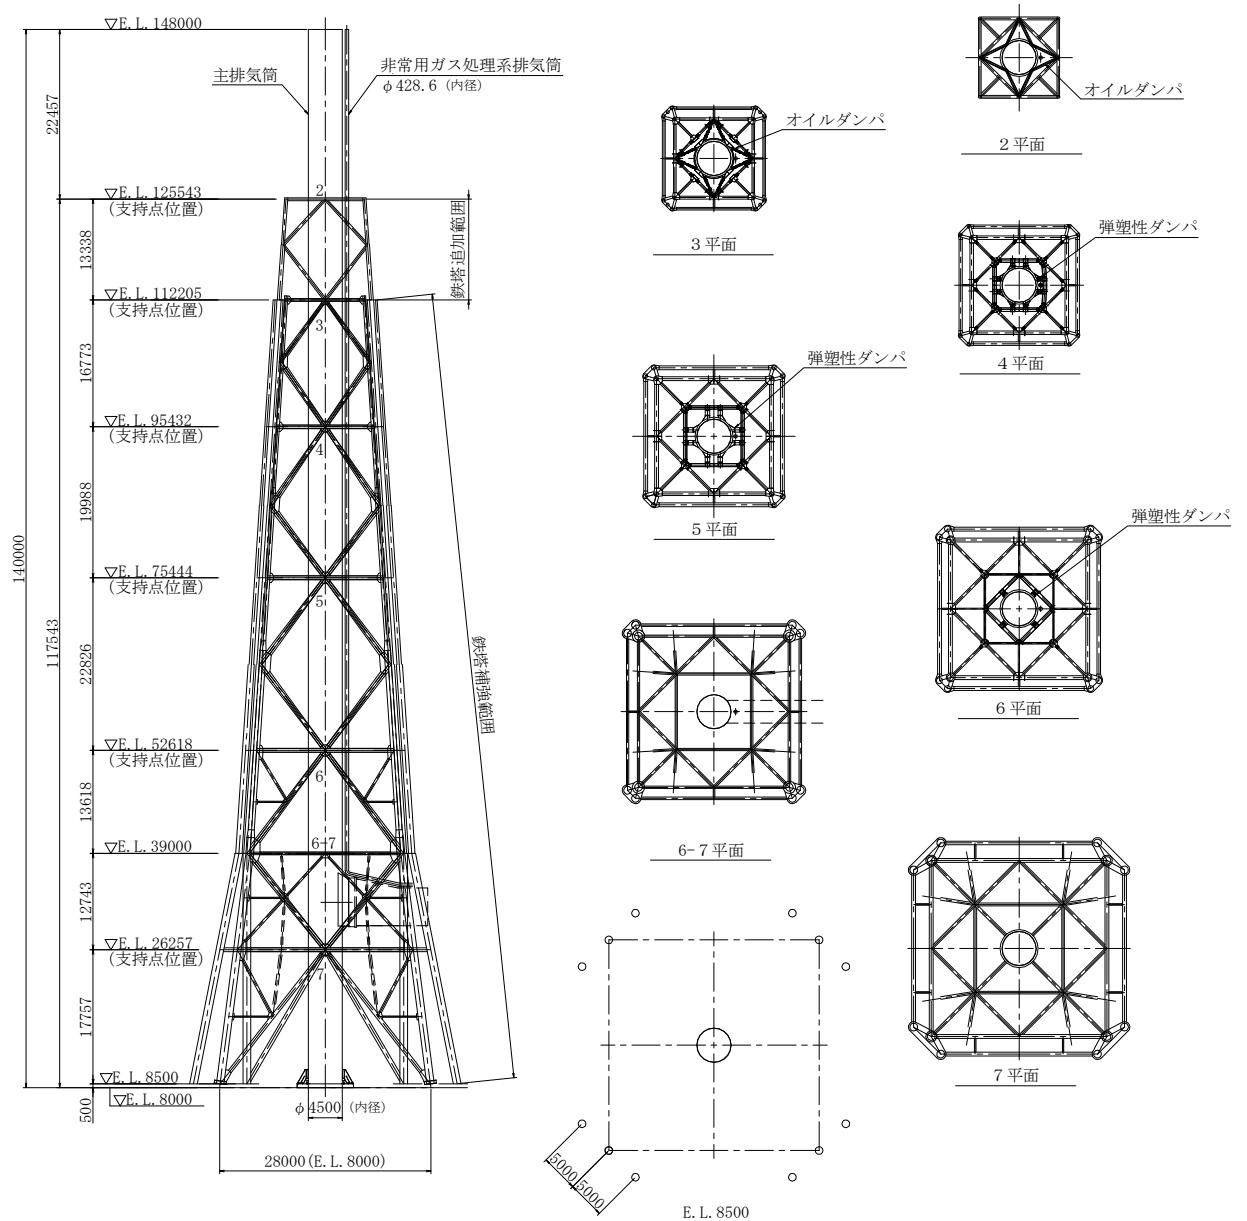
主排気筒の構造概要図 (単位 : mm)
